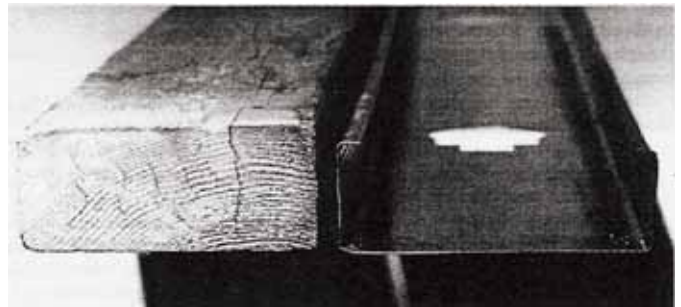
Perfis estruturais de madeira e aço galvanizado. (Fonte: Robert Scharff).
